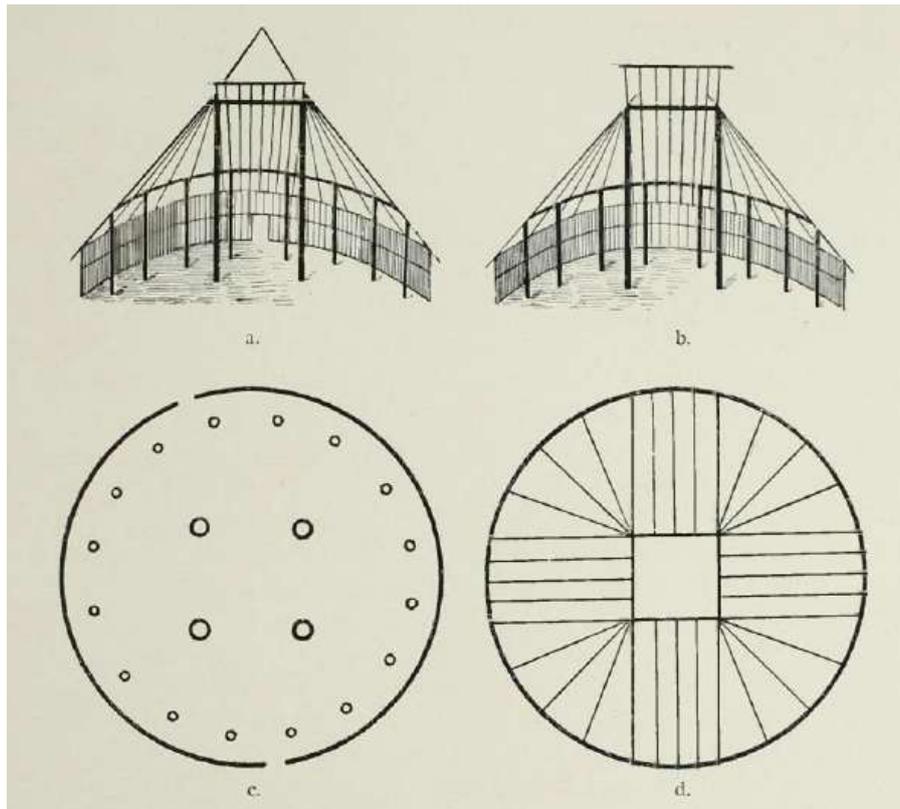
Planta de uma casa no baixo Apaporis: estrutura interna (a e b), planta baixa (c) e estrutura do telhado (d) (Koch-Grünberg 1910).
